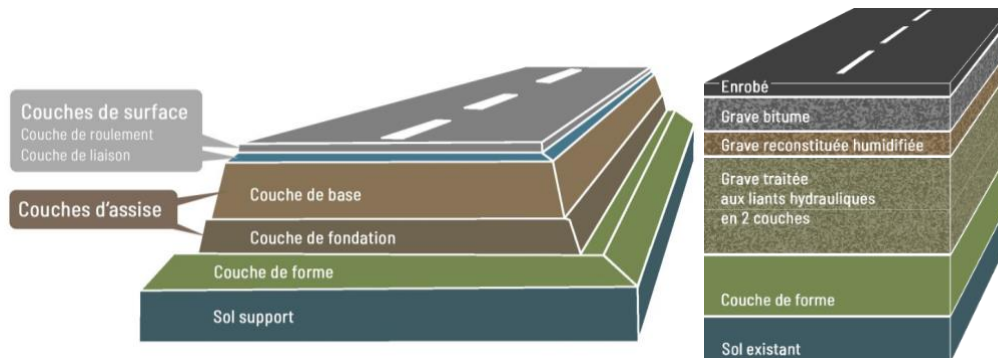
exemple de structure de chaussée (Source : [Techniroute](#))
